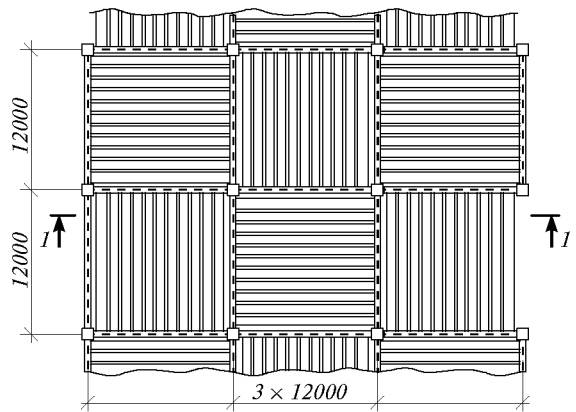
Рамный каркас с шахматным расположением плит перекрытий
